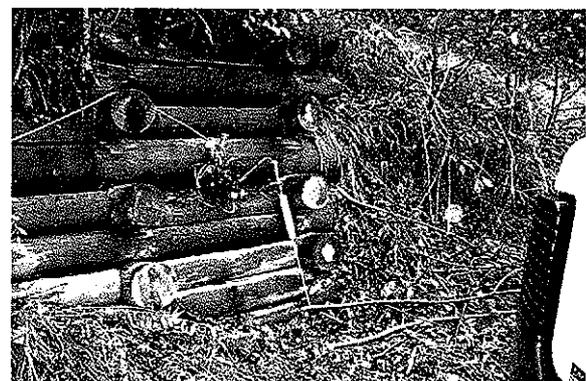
Rutschung Eggstraße: Seilextensometer – Detail 2
